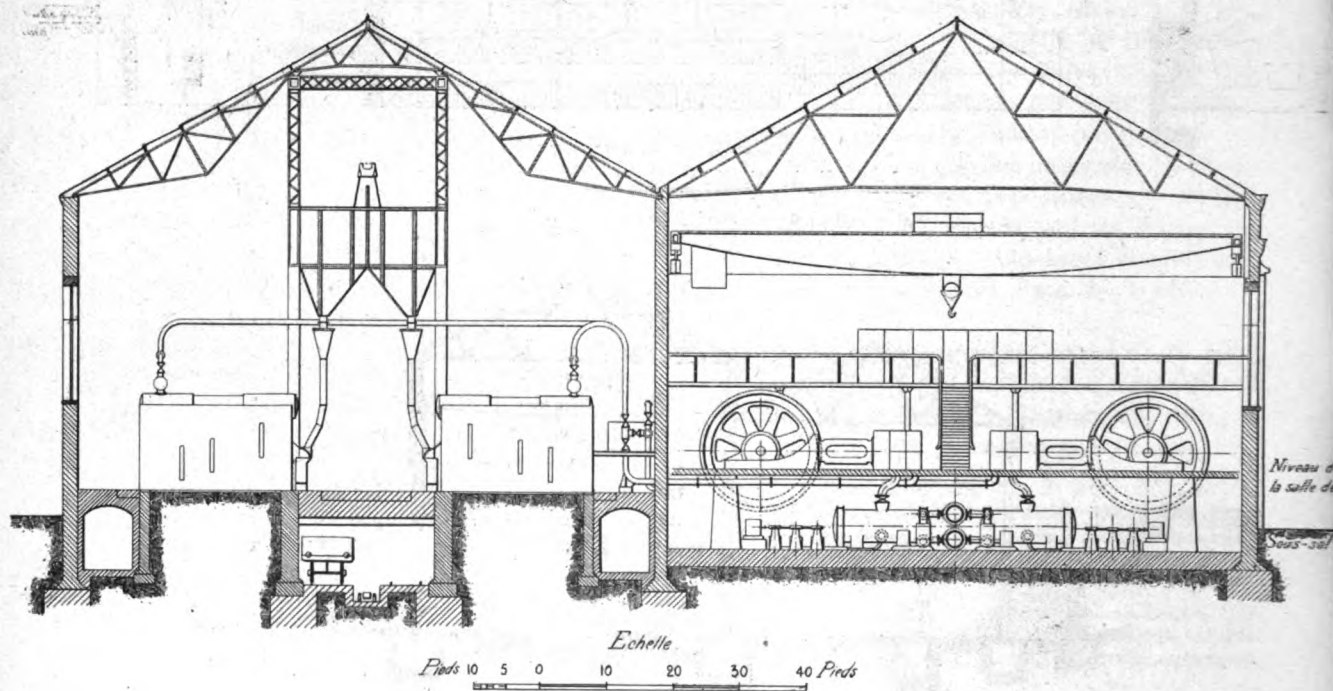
Plan d'une station génératrice avec double rangée de chaudière.
